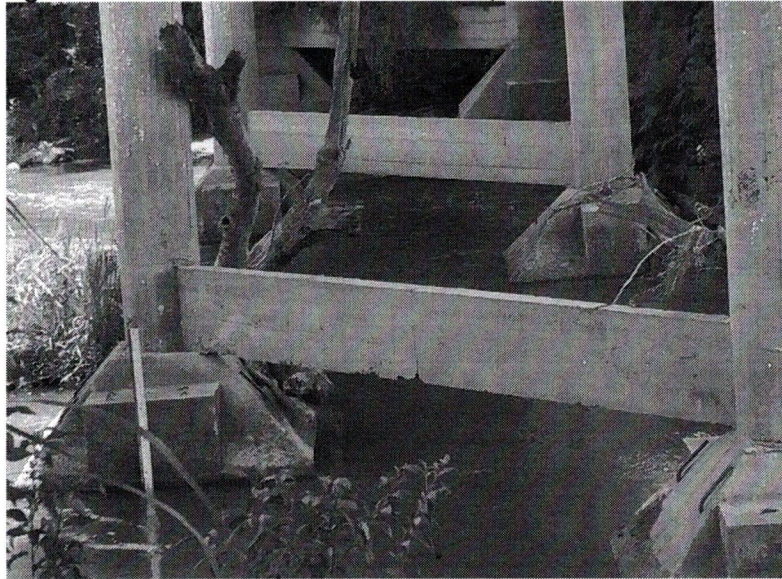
Viga Transversa com fissuras e deslocamento de concreto.
